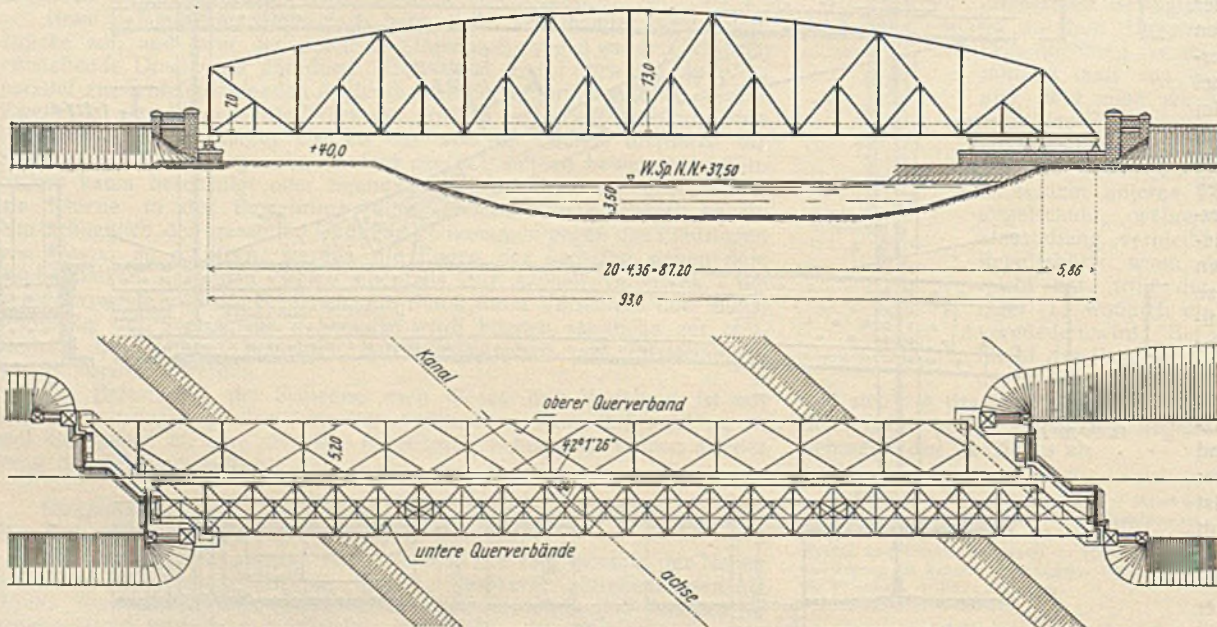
System und Grundriß der Halterner Eisenbahnbrücke.
